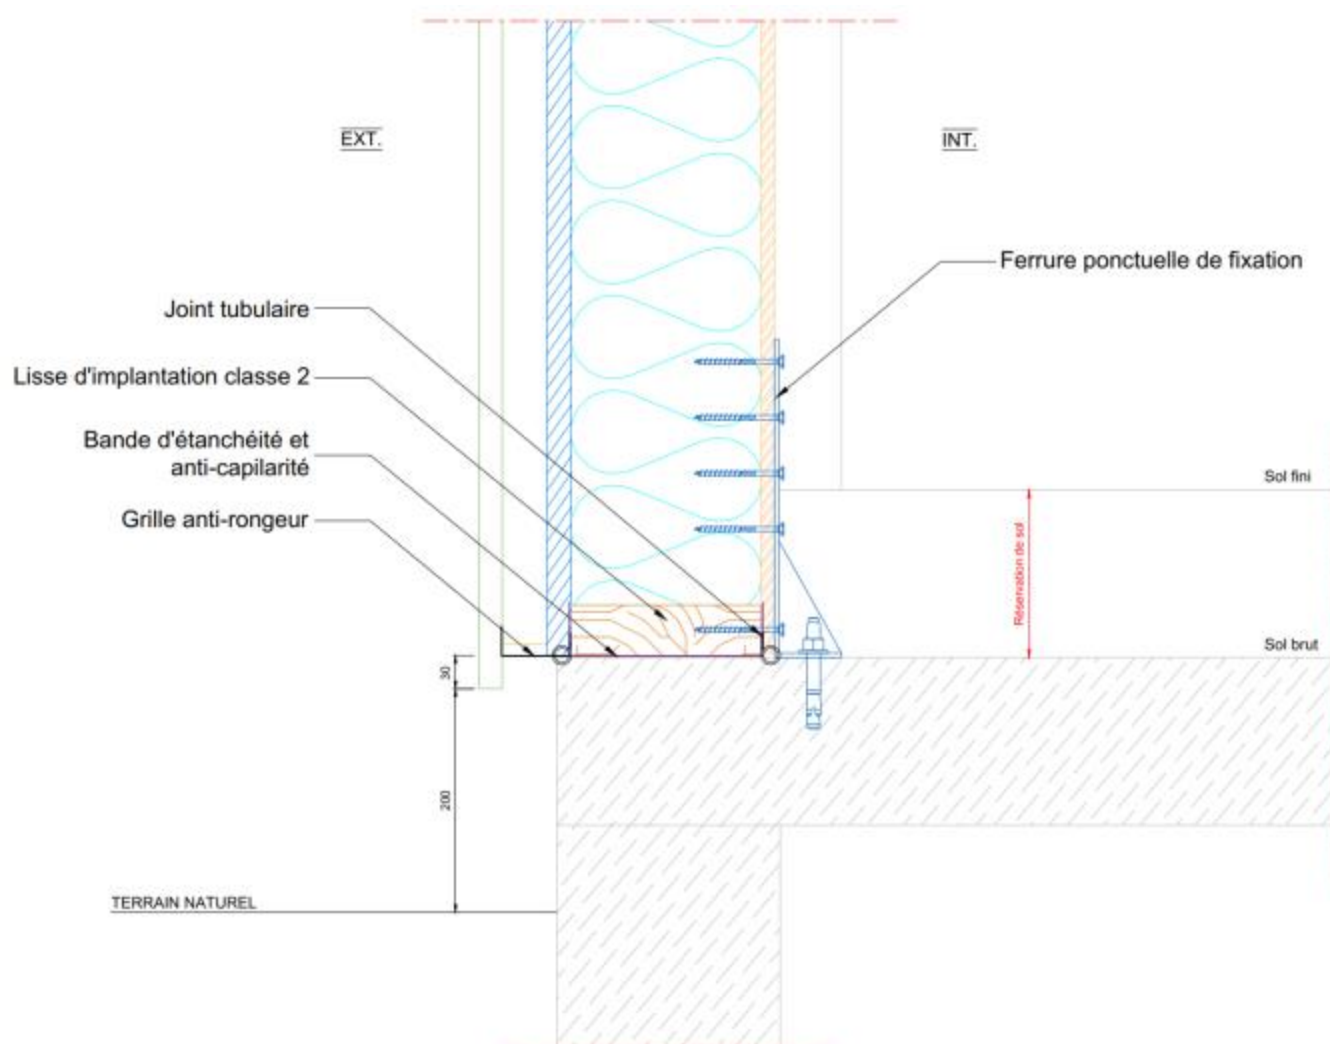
Pied de mur SYBOIS MUR – Jonction avec la dalle basse
